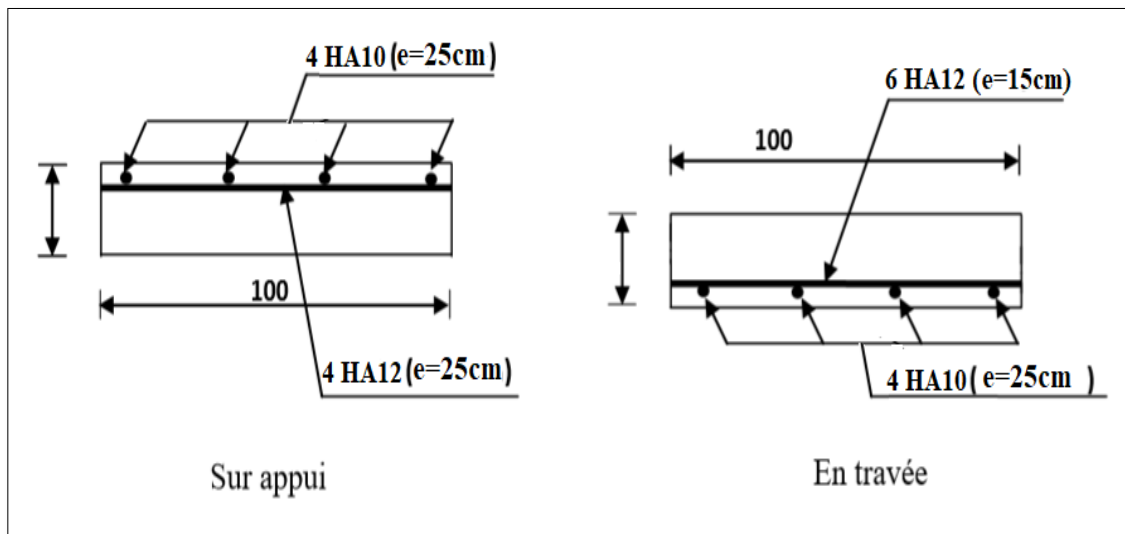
Ferrailage de l'escalier en travée et sur appuis
